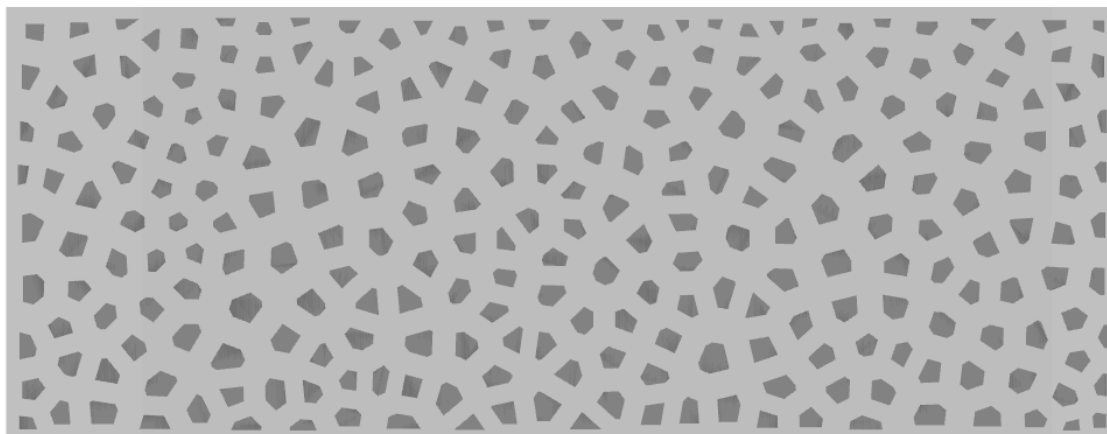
Layout final da fachada paramétrica. Créditos: Autora
